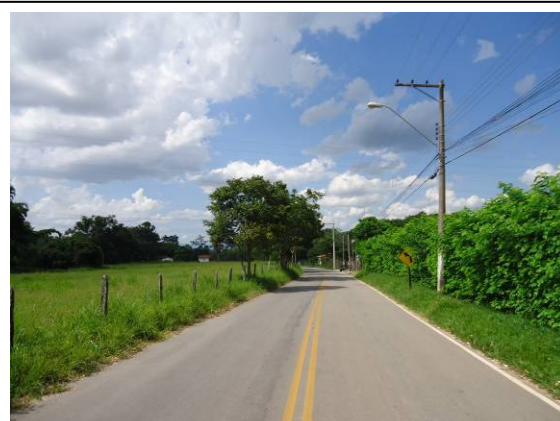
Cruzamento com a Estrada da Baraceia (SP-072), pavimentada – município de Taubaté (SP)
